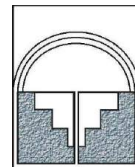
(Aldo Bolaños). . Chininea. Detalle constructivo de pared masiva y muro con vano o ventana.
